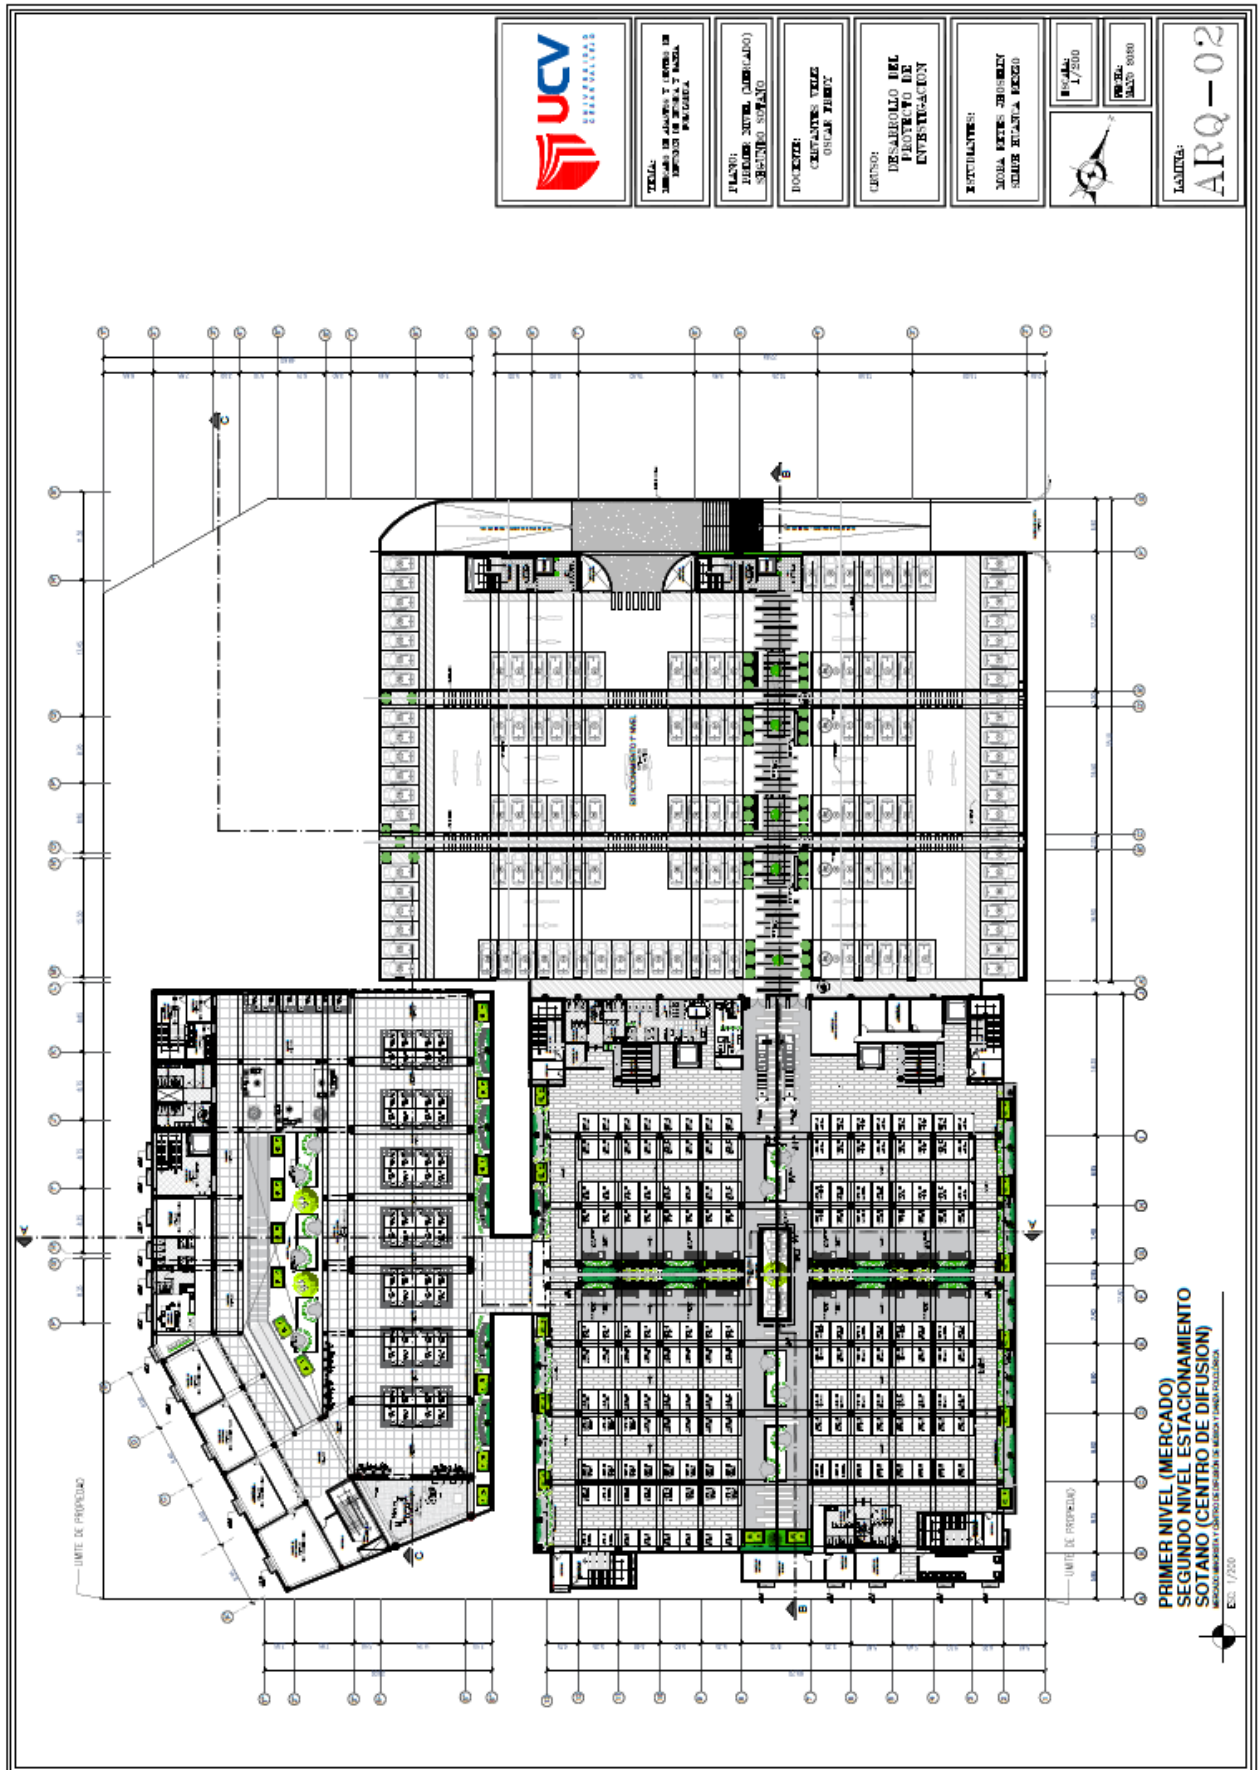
Plano Primer Nivel Mercado, Centro y Estacionamiento - Anteproyecto
